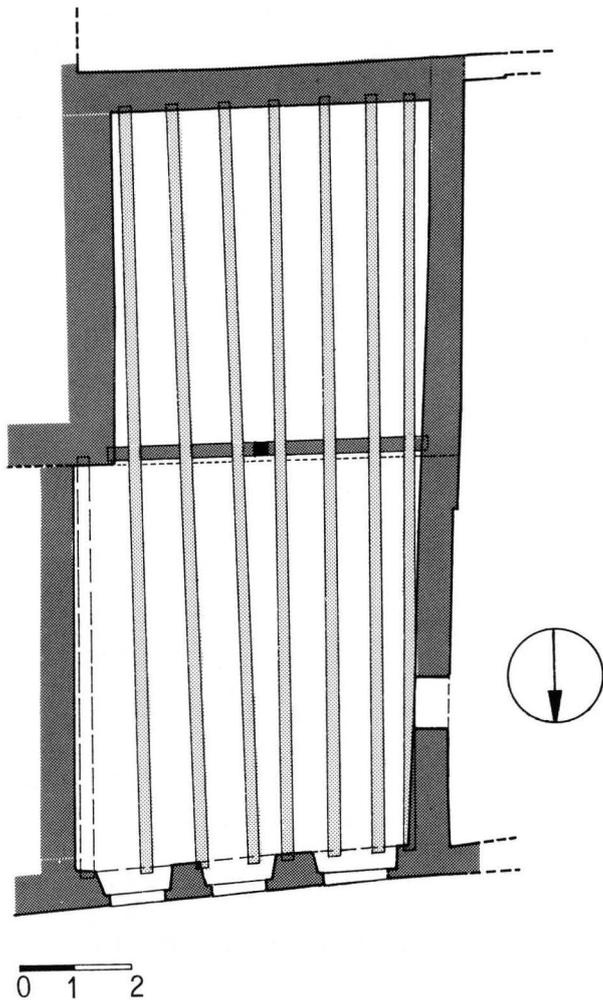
Stiftsgasse 5. Grundriss des Erdgeschosses mit Balkenlage von 1290 (Bauphase 4). – Zeichnung: St. Tramèr.
